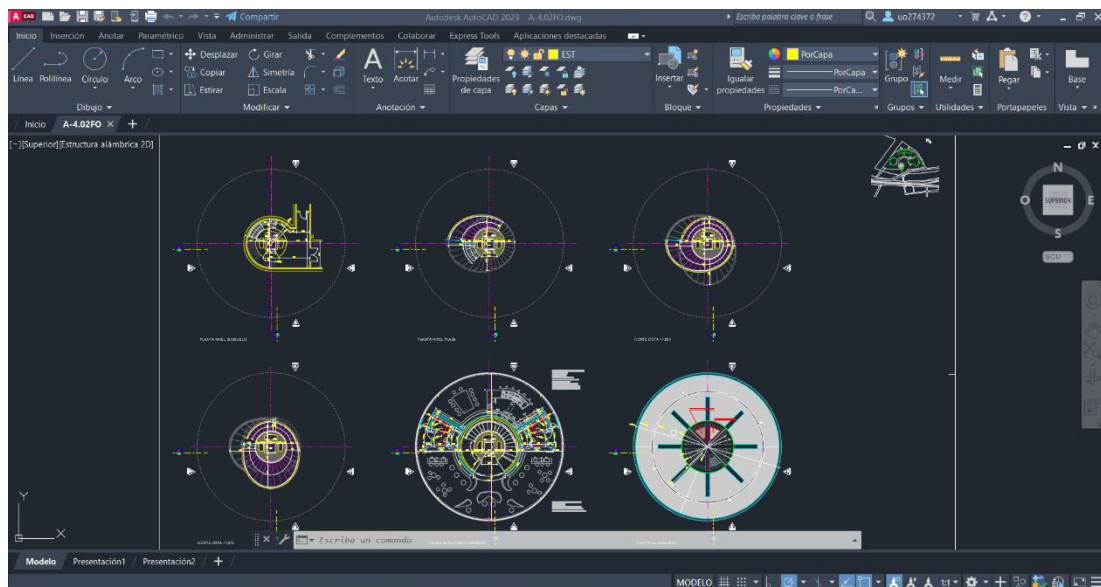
Plano de plantas (Captura de los planos originales en AutoCAD)
